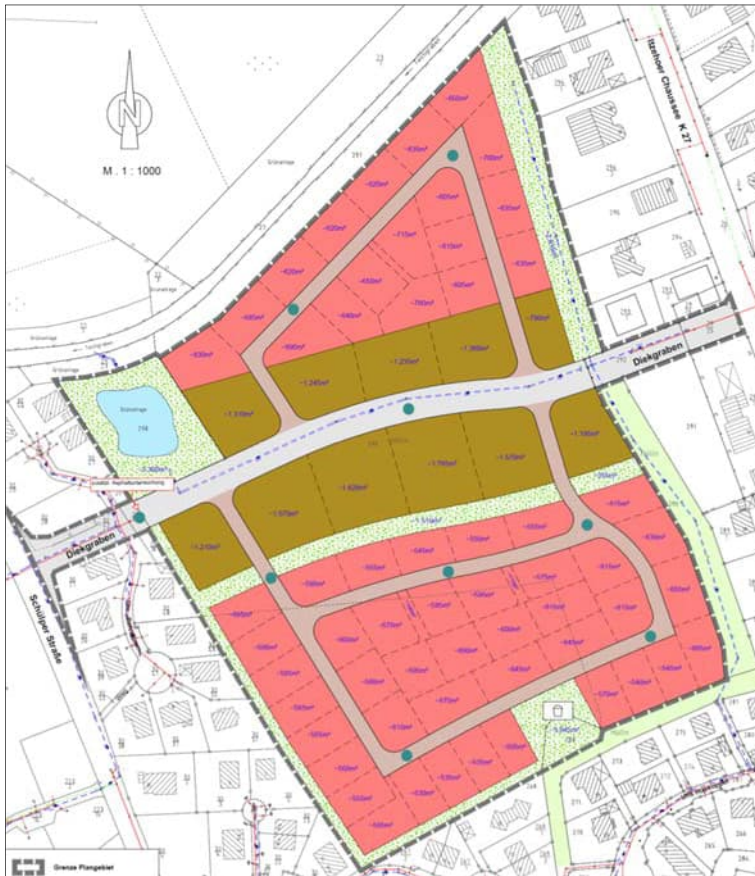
Lageplanausschnitt (Stand: 01.07.2020), (o. M.)
